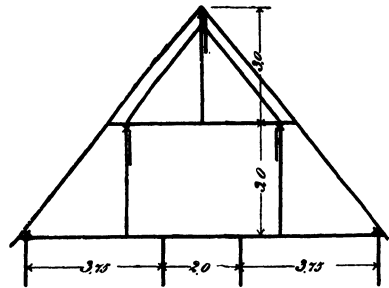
Kehlbalkendach mit doppelt stehendem Stuhl und Firstpfette.
